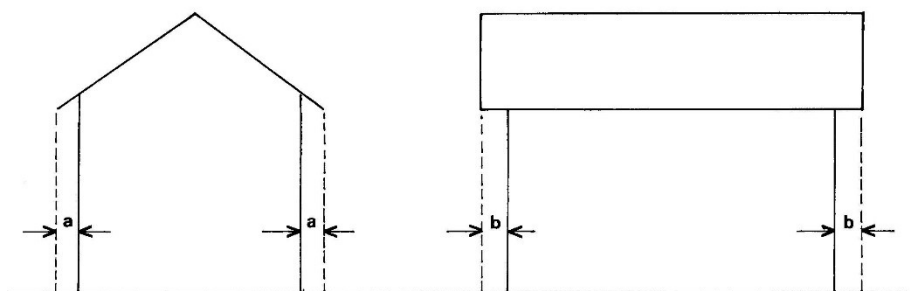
3.3 Plans des façades et projection du pied de façade
